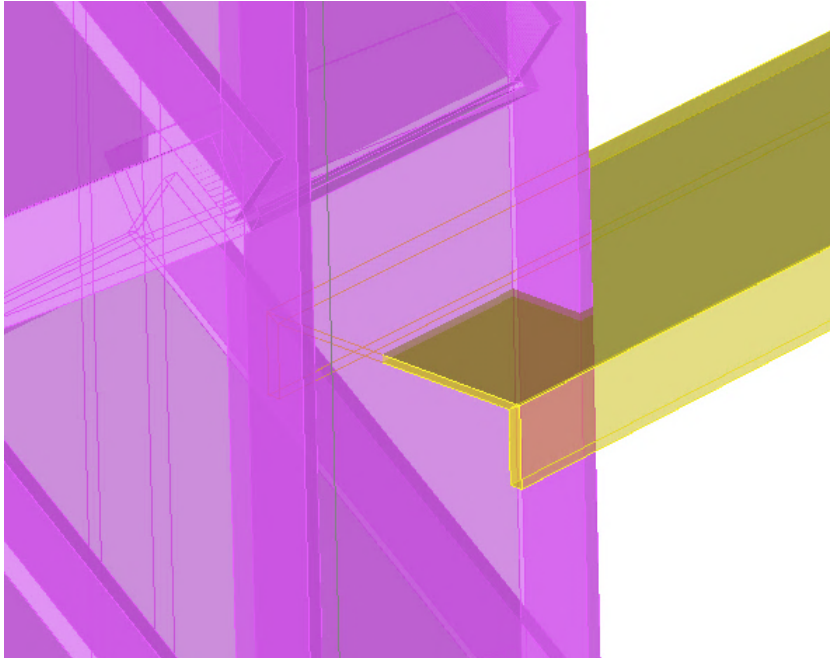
Vista tridimensional da ligação pilar | madre de fachada no SAP2000 v21.1.0
